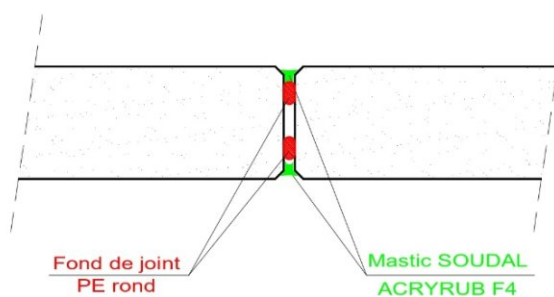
DETAIL DES JOINTS INTERIEURS HORIZONTALS NON COUPE-FEU
